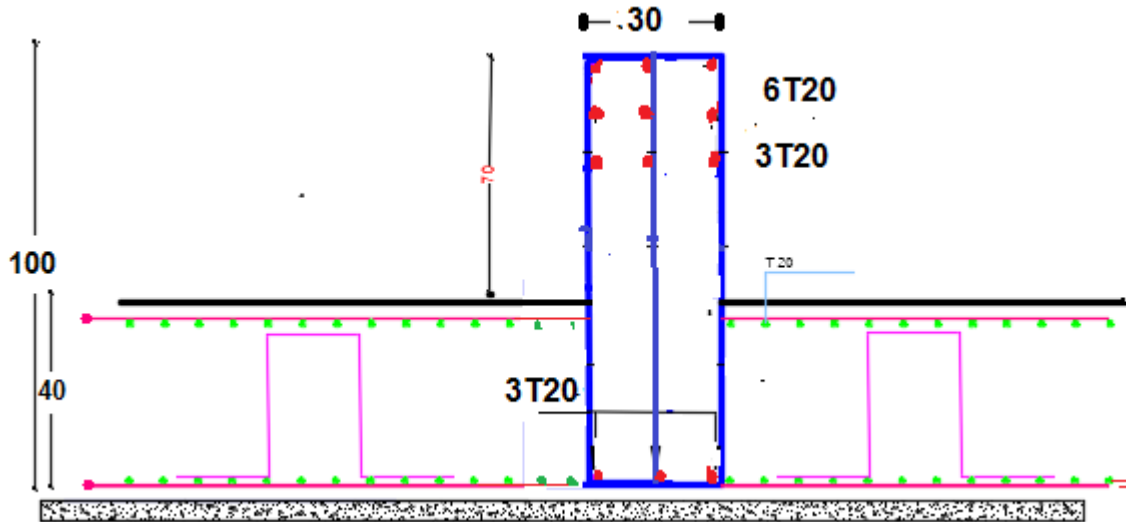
dessin de ferrailage d'une poutre secondaire en appuis.
